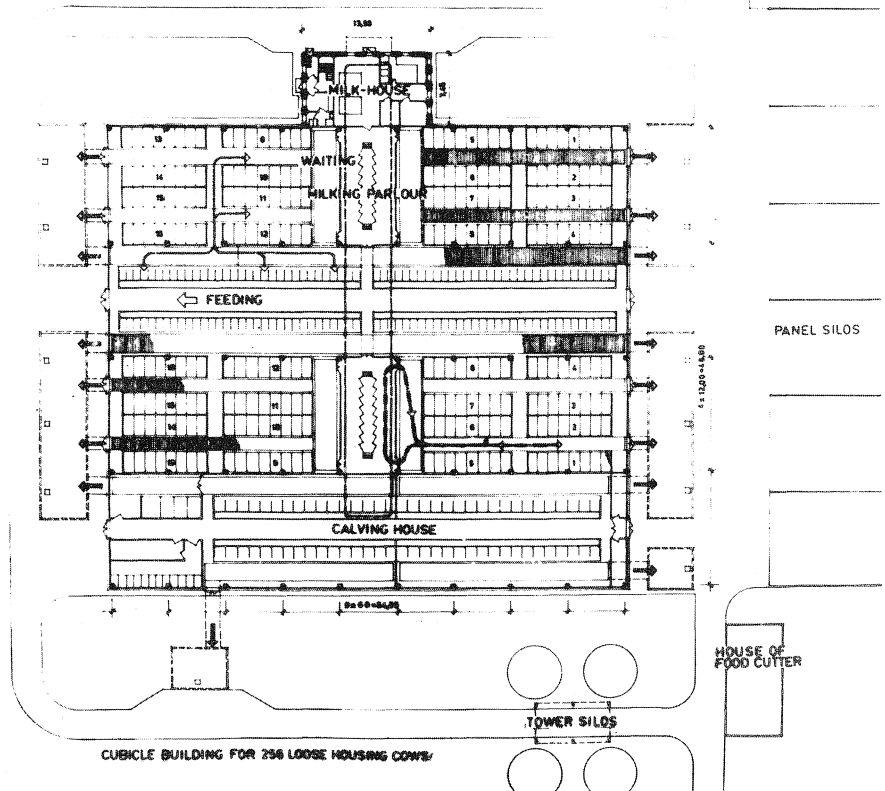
Funktionsplan zu Bild 2. Liegeboxenlaufstall mit Fischgrätenmelkständen (2 x 7) und Spaltenbodenaufläufen (Blockbauweise)
